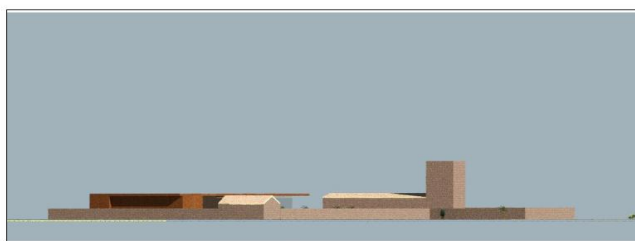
Vista forntal de la solución propuesta. Alzado Sur.
